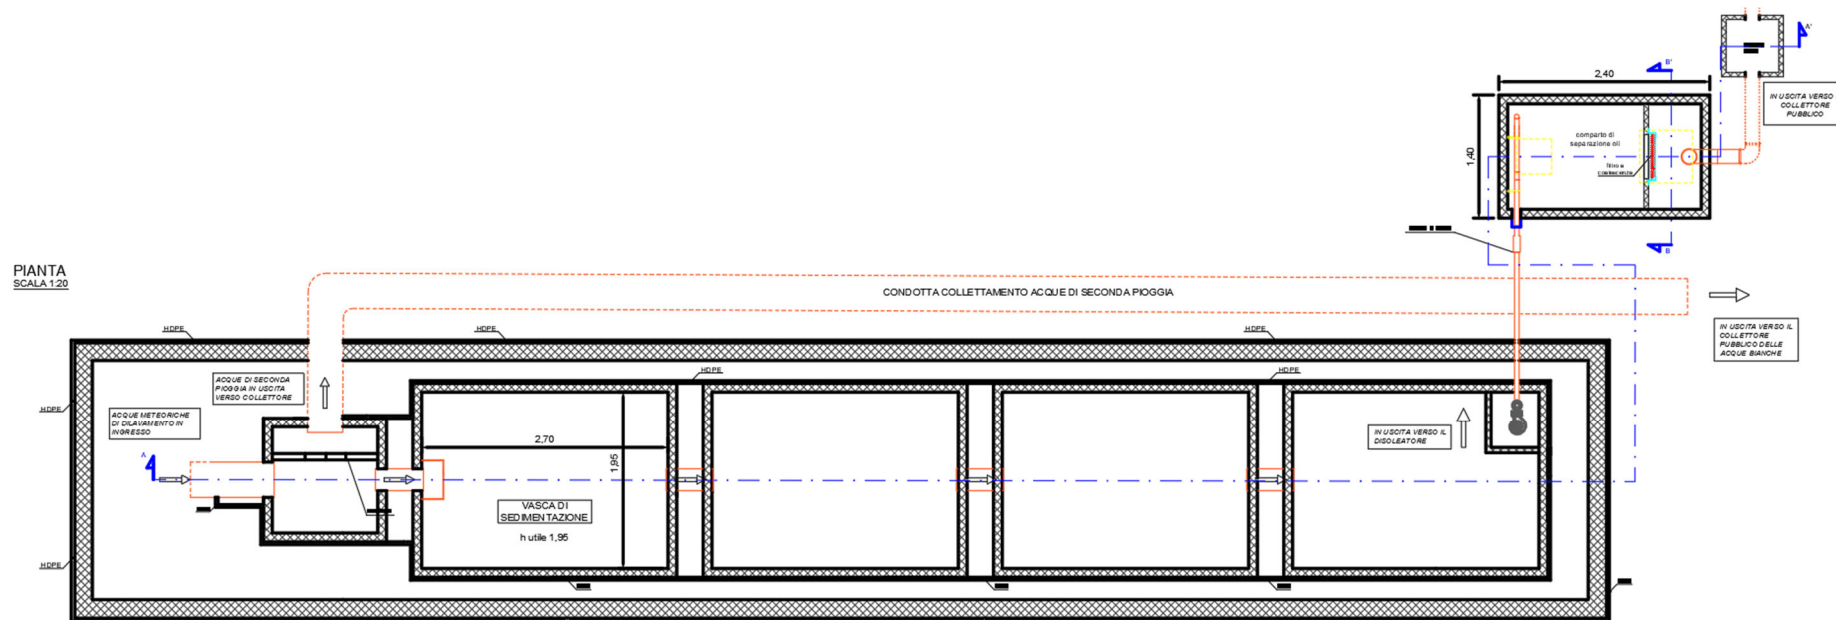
Planimetria Impianto trattamento acque di prima pioggia
